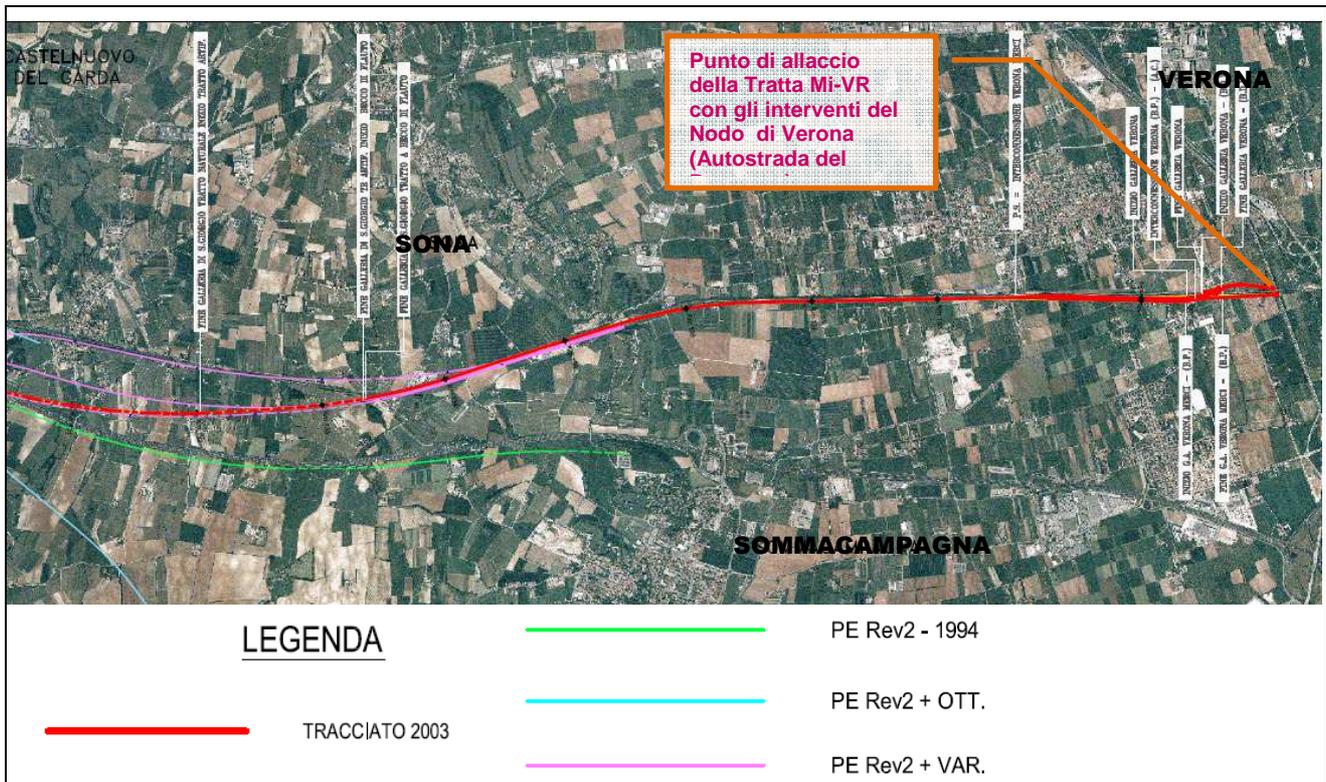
Stralcio della planimetria con l’evoluzione storica del progetto e le alternative di tracciato (SIA 2003 tratta Milano – Verona)
